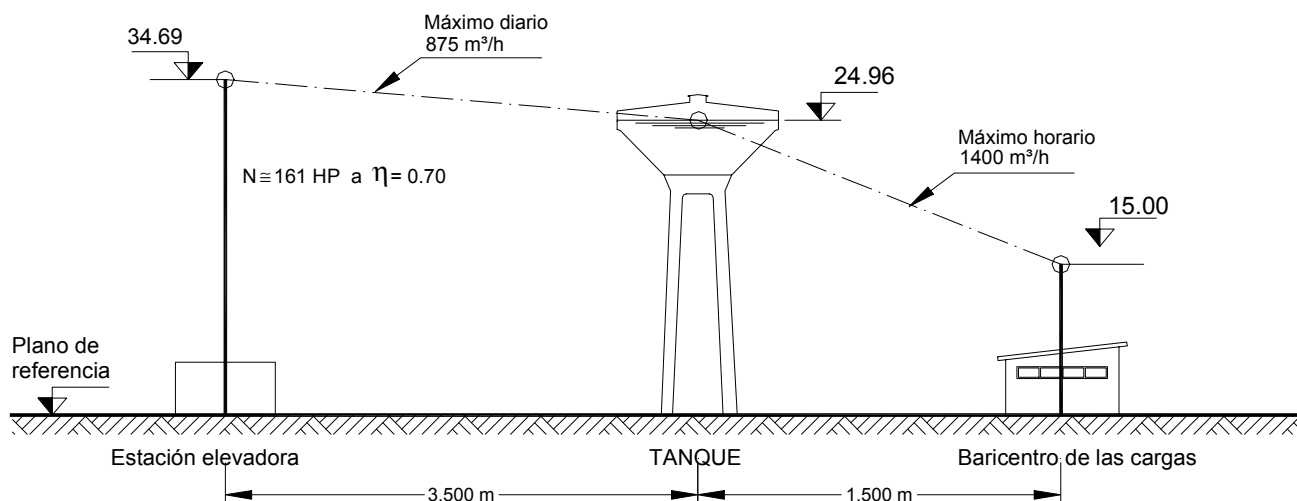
Tanque entre estación elevadora y baricentro de las cargas
